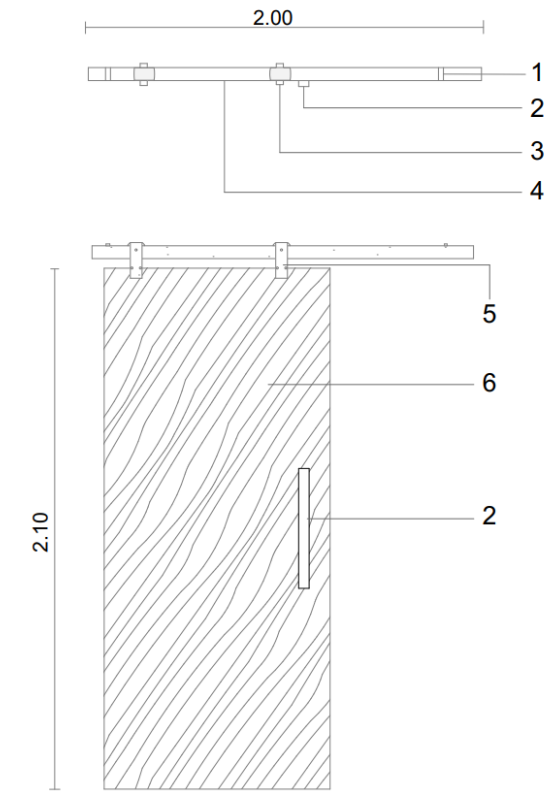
Detalle constructivo de dormitorio de puerta corrediza
